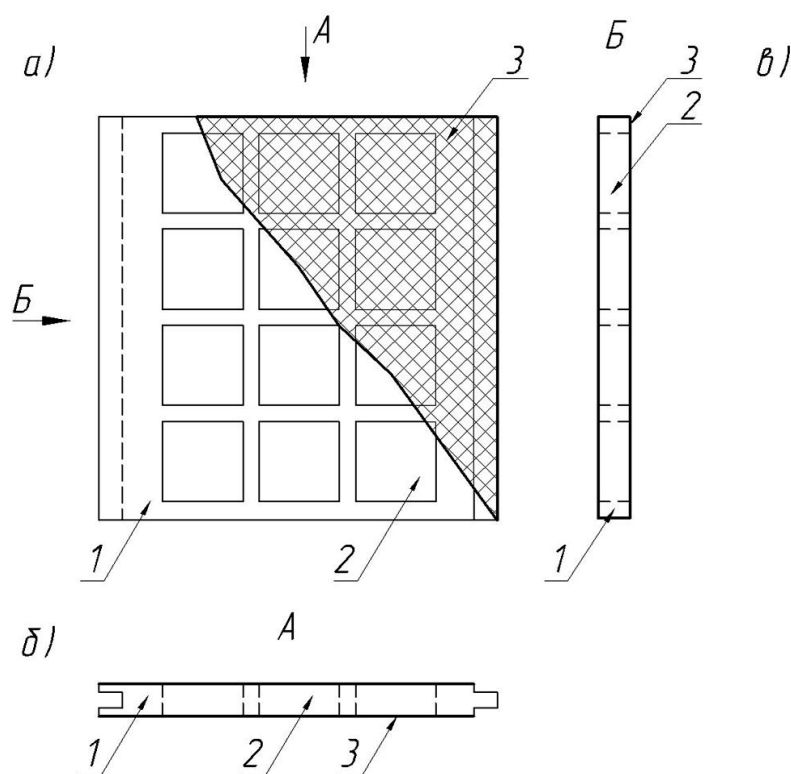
Разделительная железобетонная стенка с отверстиями:
